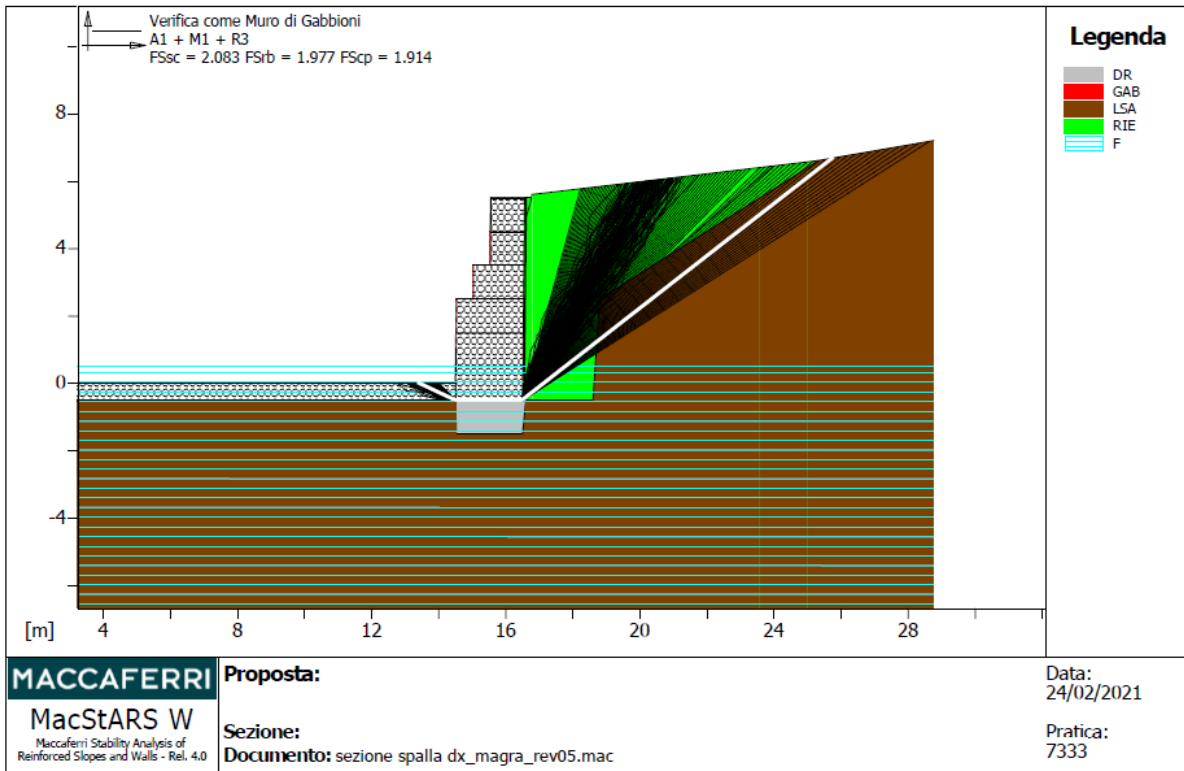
Verifica di stabilità globale sezione spalla dx- condizione di magra-statica
